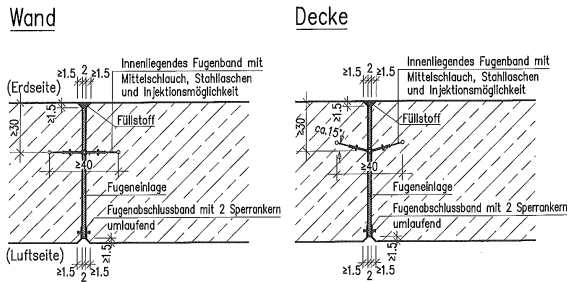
Raumfuge Wand / Decke, Tunnel offene Bauweise
